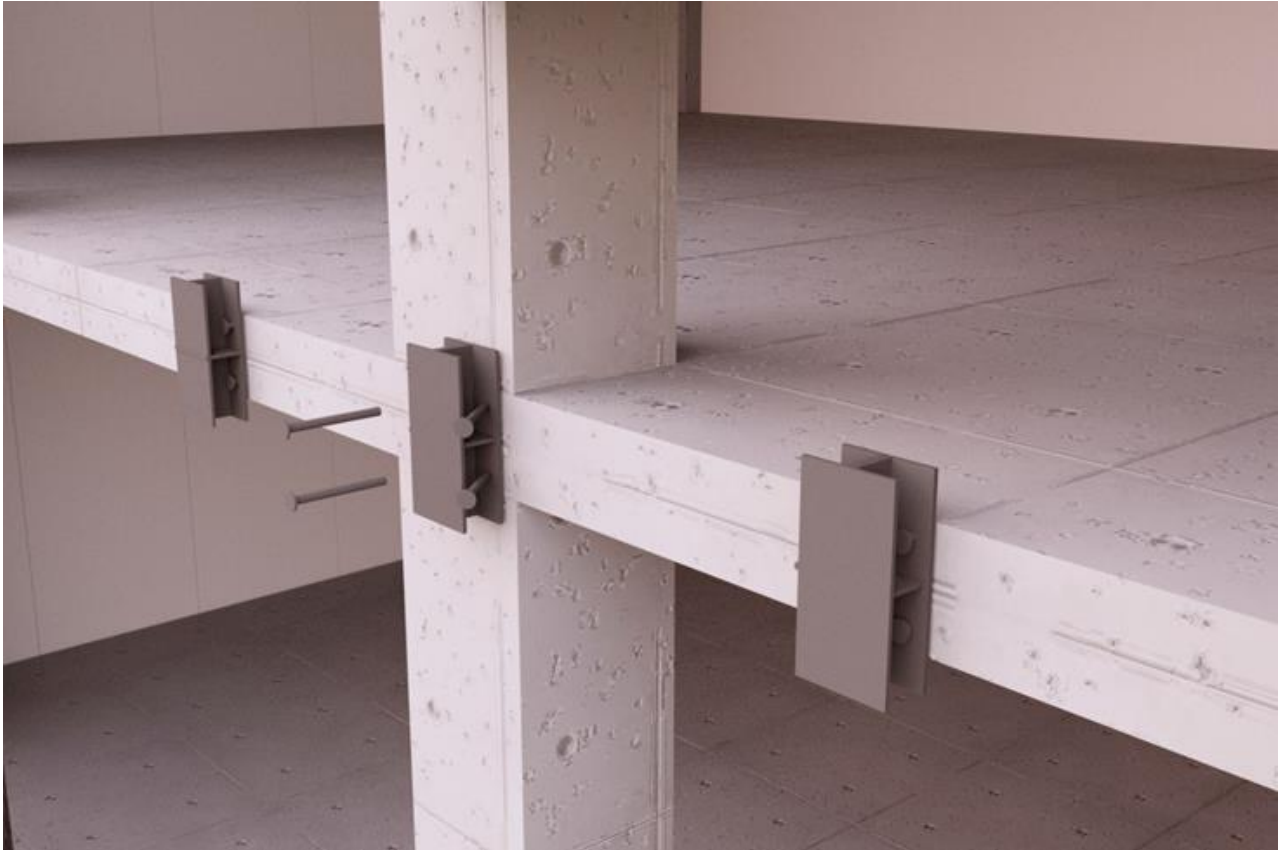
Кріплення опорного елемента до торця монолітної плити перекриття.
